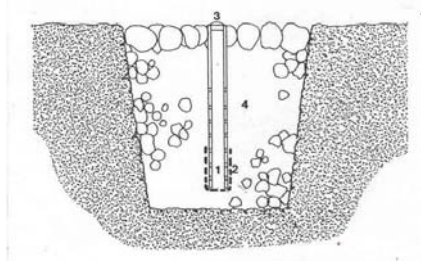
1.- Tubería perforada o abierta, 2.- Geotextil, 3.- Tapa, 4.- Relleno.
